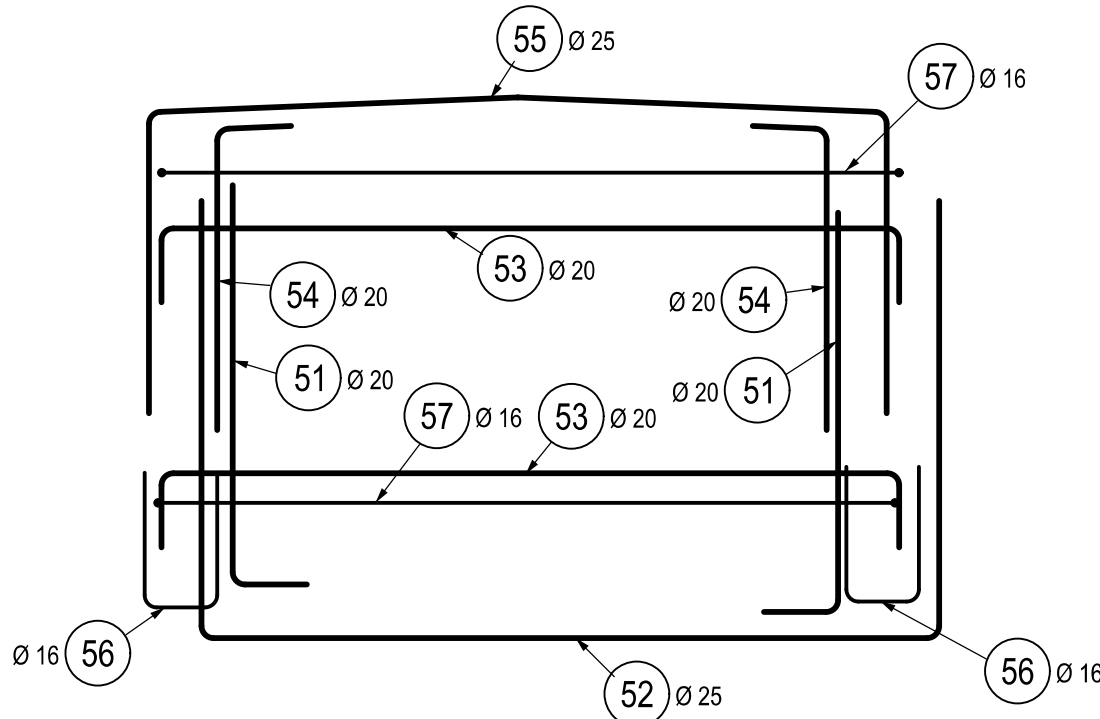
DETAIL VÝZTUŽE POD KOTVOU ZÁVĚSU, 1:25
